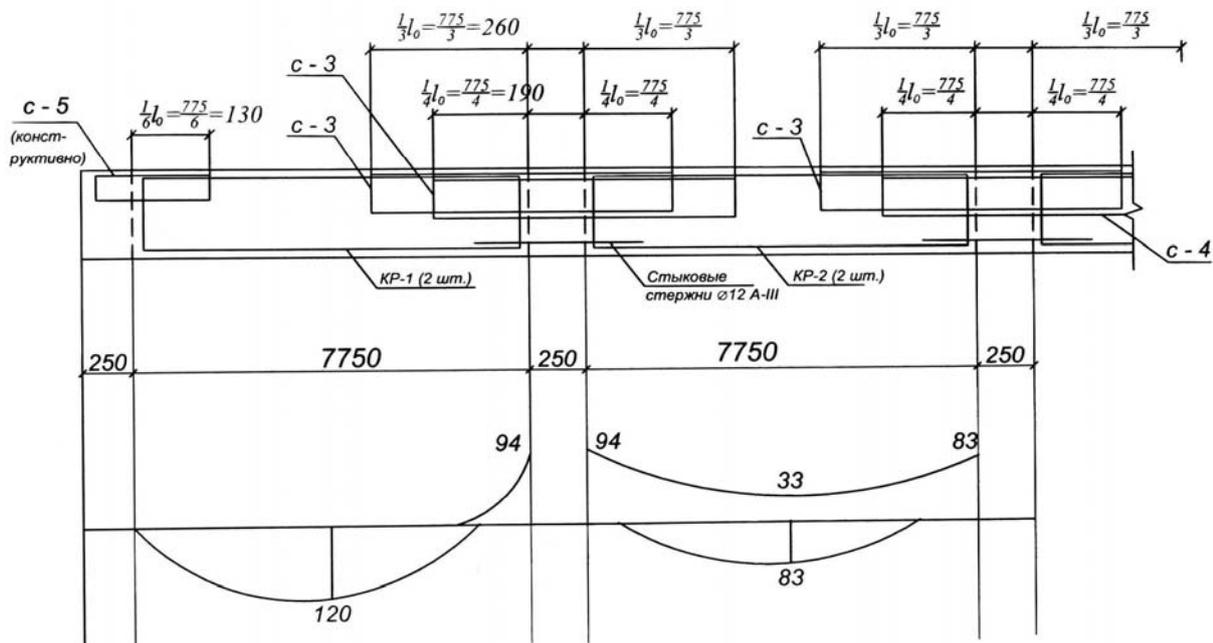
Схема армирования второстепенной балки. Эпюра M.
